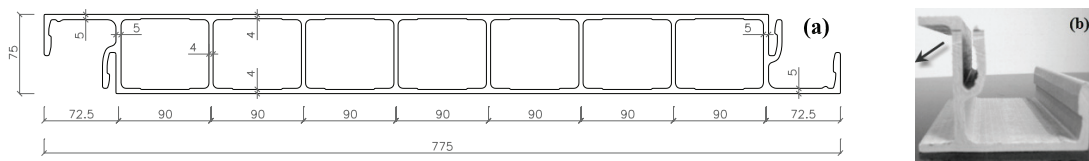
(a) Secção transversal do painel SF75L (dimensões em mm), com pormenor à direita (b) de uma aba da extremidade da secção para encaixe sob pressão, tipo "snap-fit".
